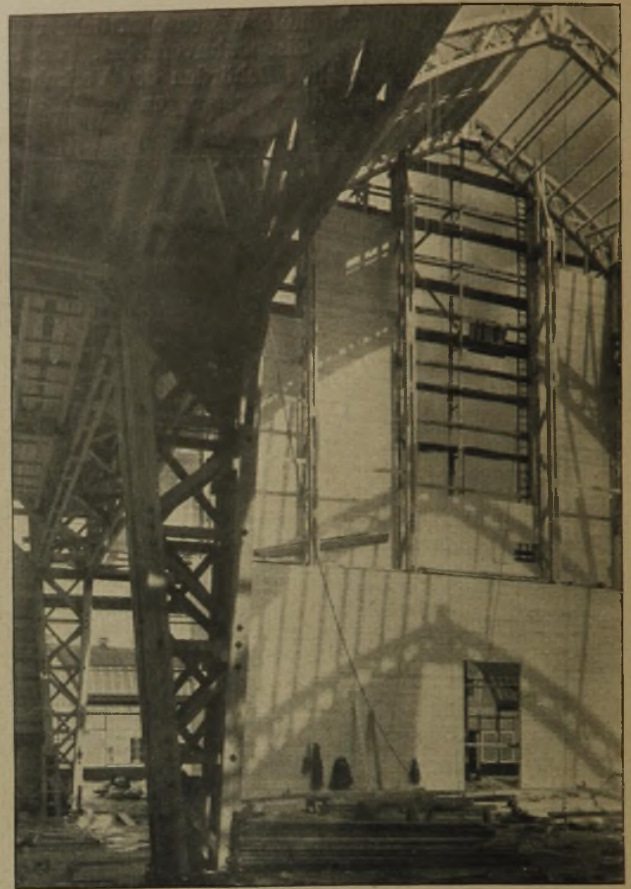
Halle für Luftfahrt i.d. Montage (Holz).
